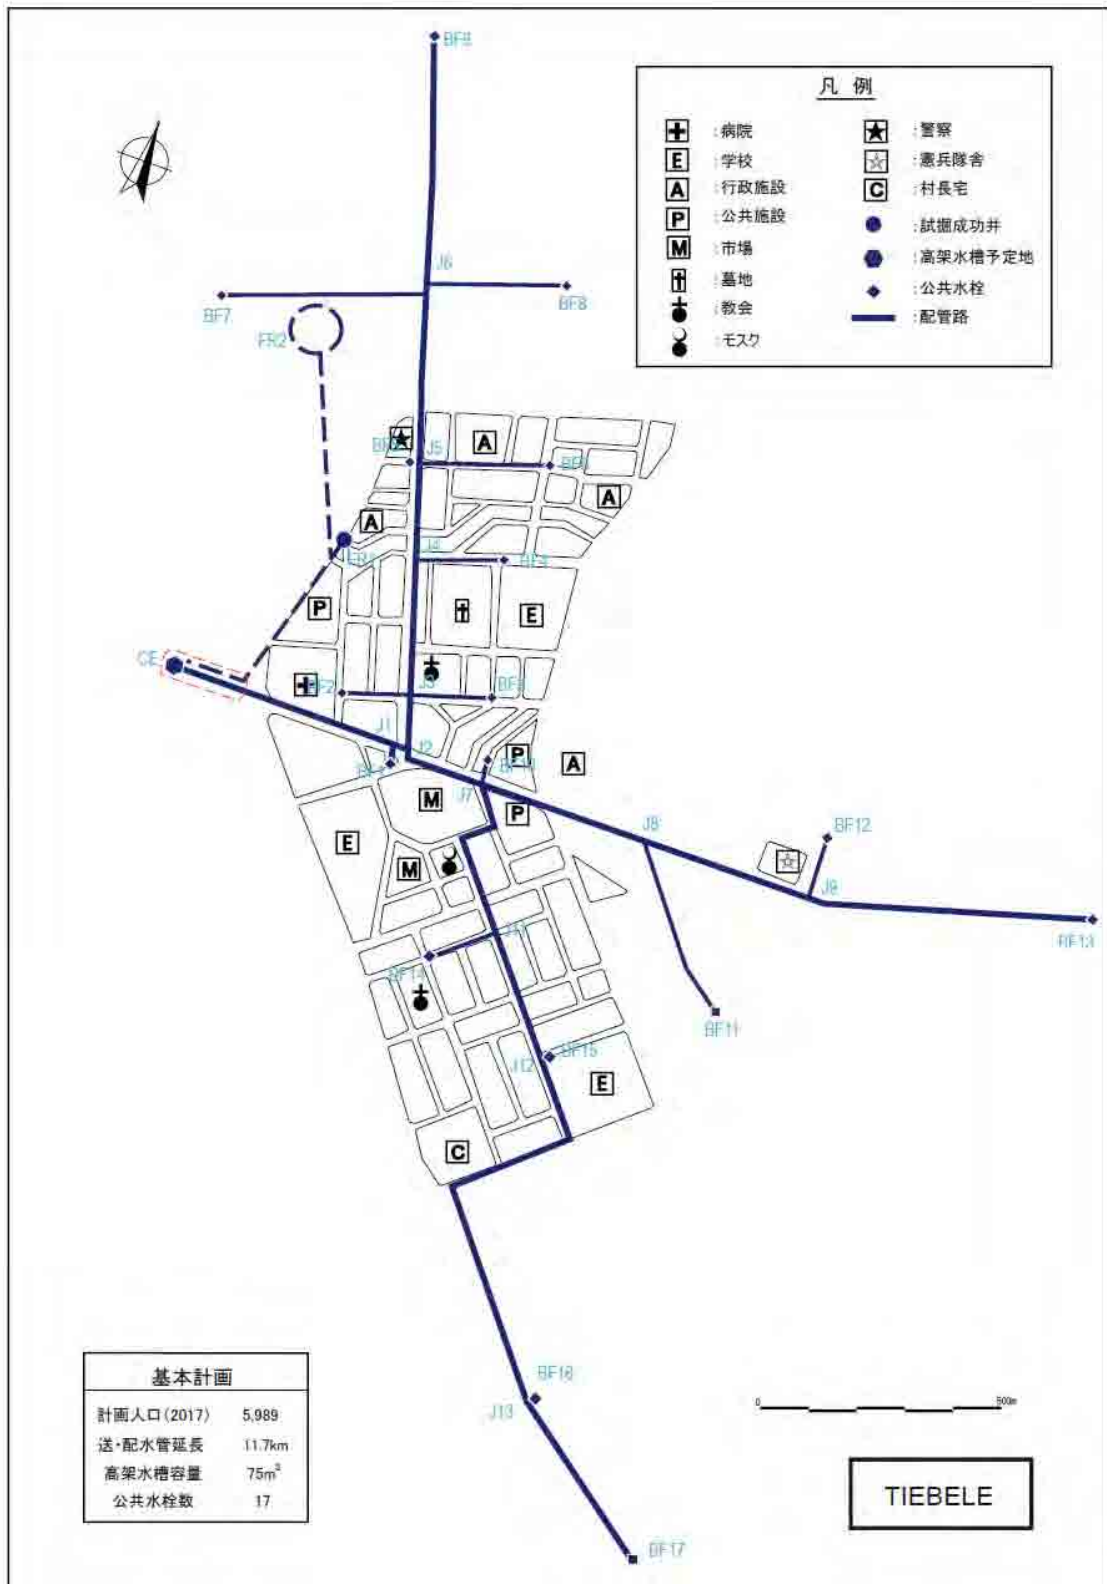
計画対象サイト(Tiébéle)の給水施設平面図
